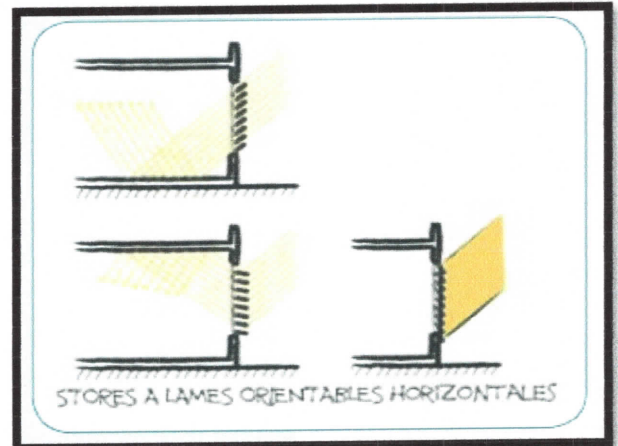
protection solaire par stores source (Groupe de travail de l'ICEB)
